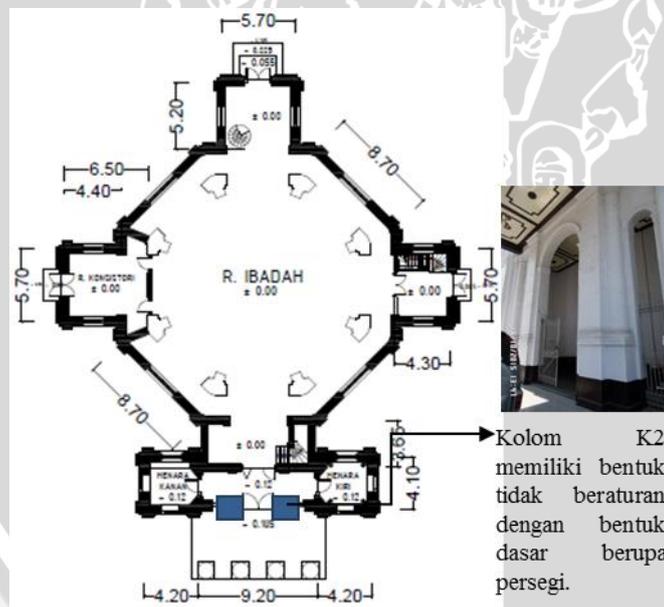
Ukuran kolom K1 pada fasade bangunan Gereja Blenduk.
